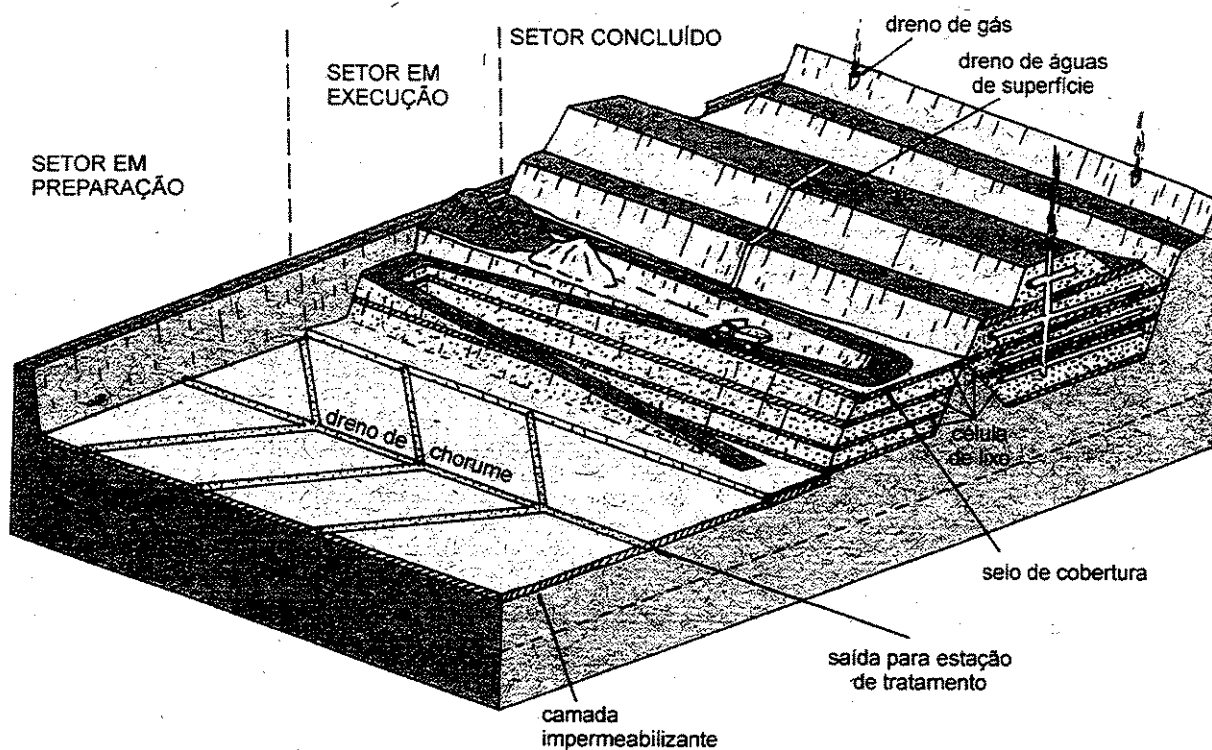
Esquema de construção e operação de um aterro sanitário
